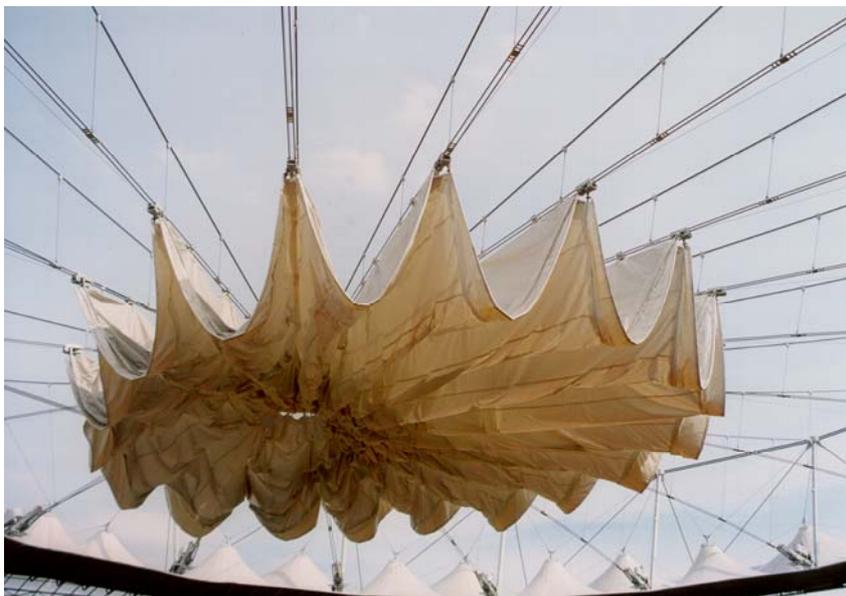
Bewegliches Dach des Center Court am Rothenbaum,
